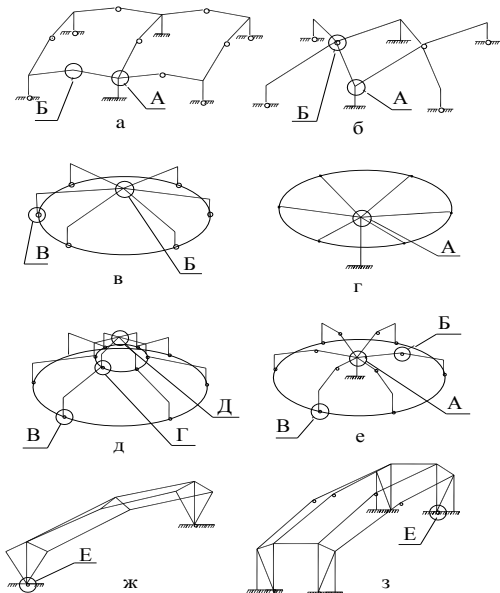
Конструктивні схеми каркасів споруд із залізобетонних рам: а - блок- модуль з чотирьох рам; б - блок- модуль з двох рам; в - схема каркасу круглого в плані; г - схема каркасу круглого в плані з єдиним стояком; д - схема каркасу круглого в плані типу башта; е - схема каркасу круглого в плані з центральним стояком; ж - схема каркасу з трьох рам; з - схема каркасу з чотирьох рам; А, Б, В, Г, Д, Е - вузли з'єднань елементів каркасу
